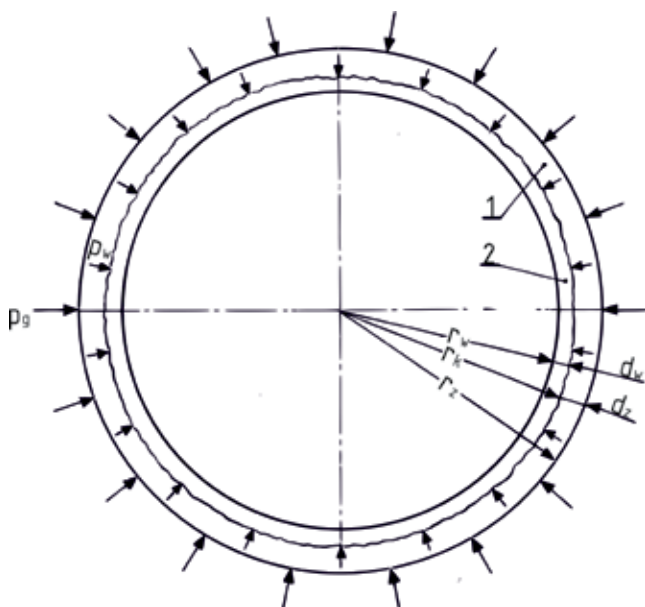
Obudowa zespolona stalowo-betonowa.
